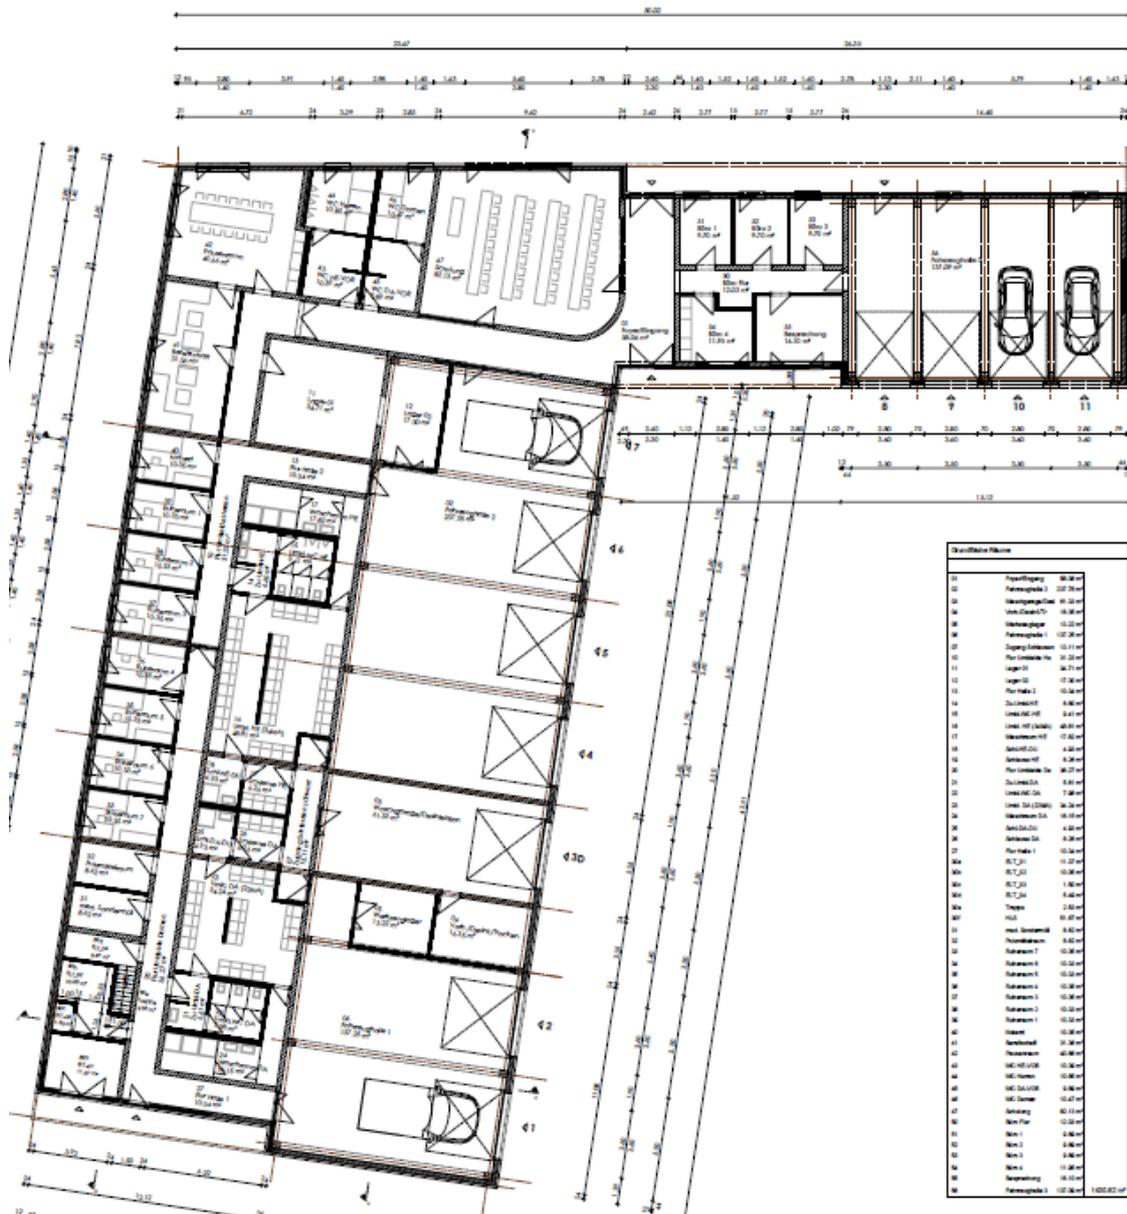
möglicher Grundriss Erdgeschoss – unmaßstäblich (Entwurf: pgf – Stand: 07.2022)
